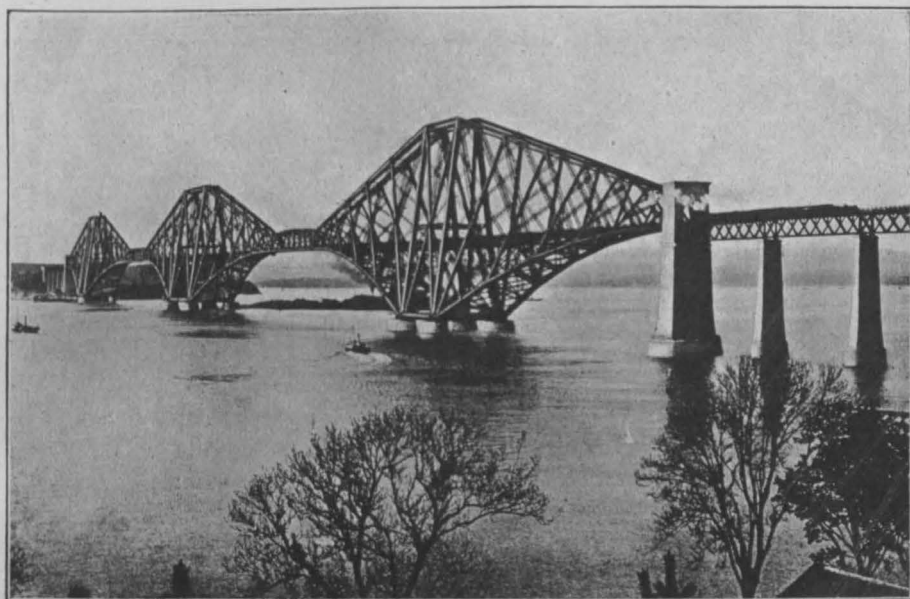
Eisenbahnbrücke über den Firth of Forth bei Queensferry, 1882—1889.
